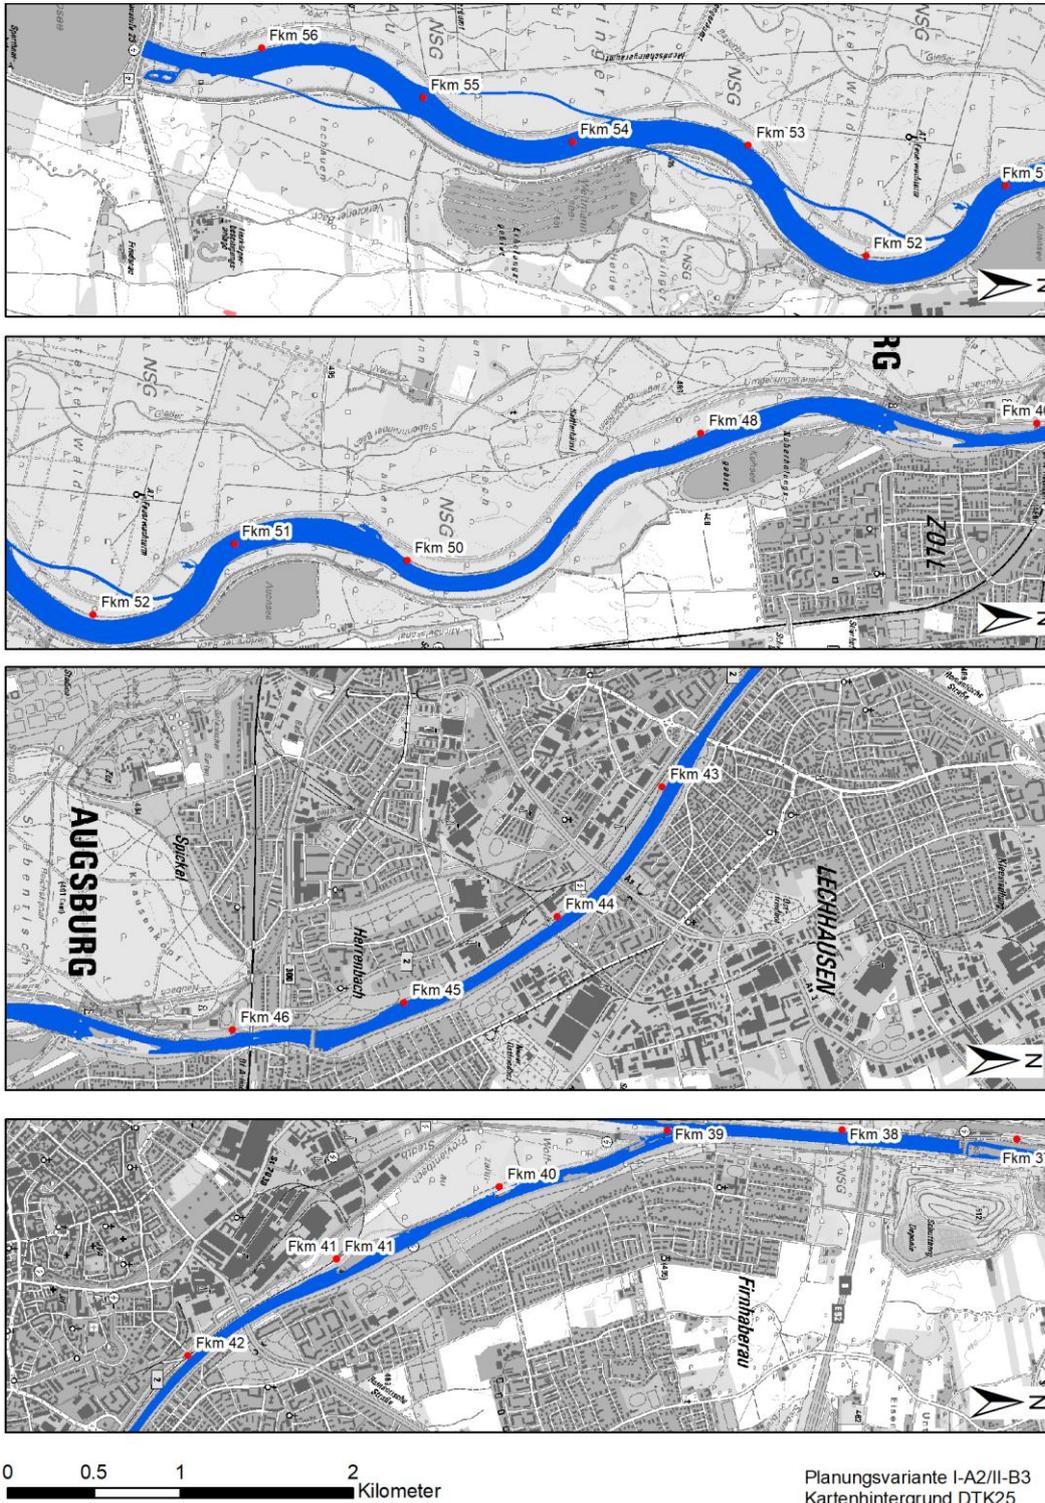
Lageplan der Planungsvariante I-A2/II-B3
